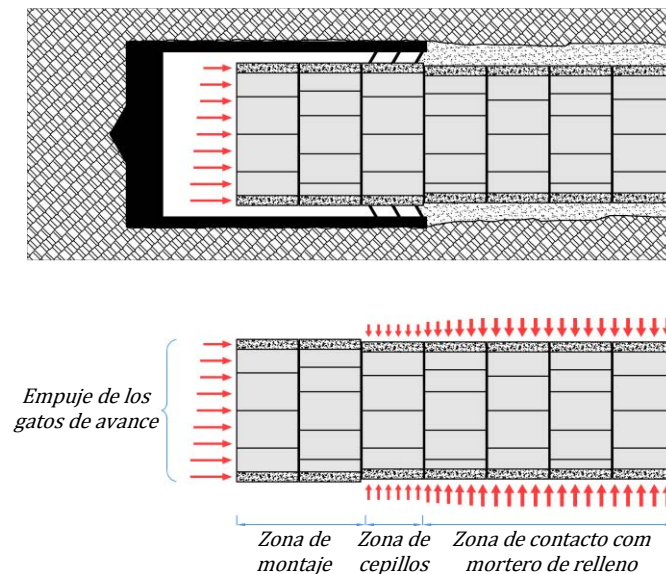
Vista esquemática de las cargas alrededor del anillo en la fase de construcción
